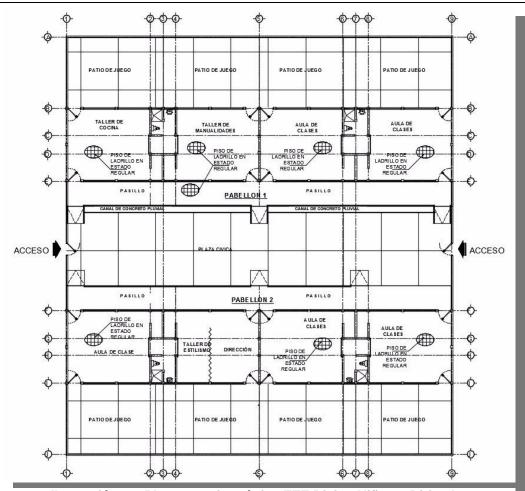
Planta arquitectónica EEE Divino Niño en Diriamba
